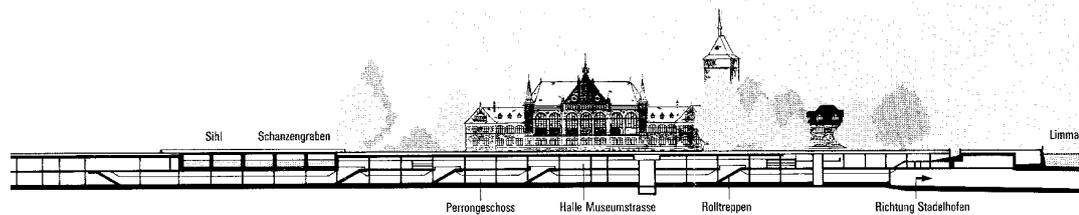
Schnitt S Bahnhof Zürich [6]
